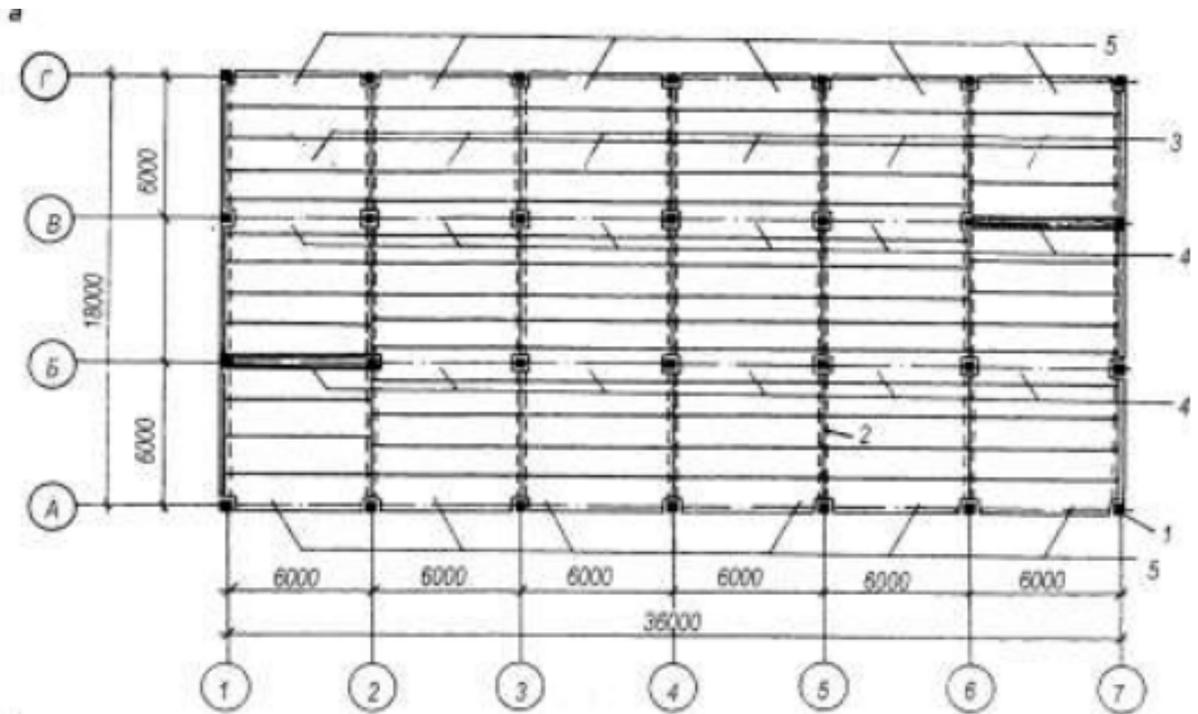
Переkritтя збірного залізобетонного зв'язкового каркаса:
